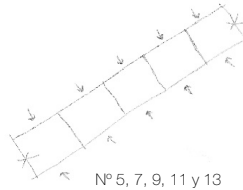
Bocetos en planta de la disposición de las construcciones situadas en la Rúa Moaña-Coia, nº 5, 7, 9, 11 y 13 (autoría propia).
